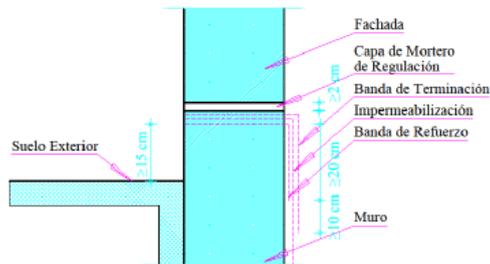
Encuentro del muro con fachadas. Fuente CTE
